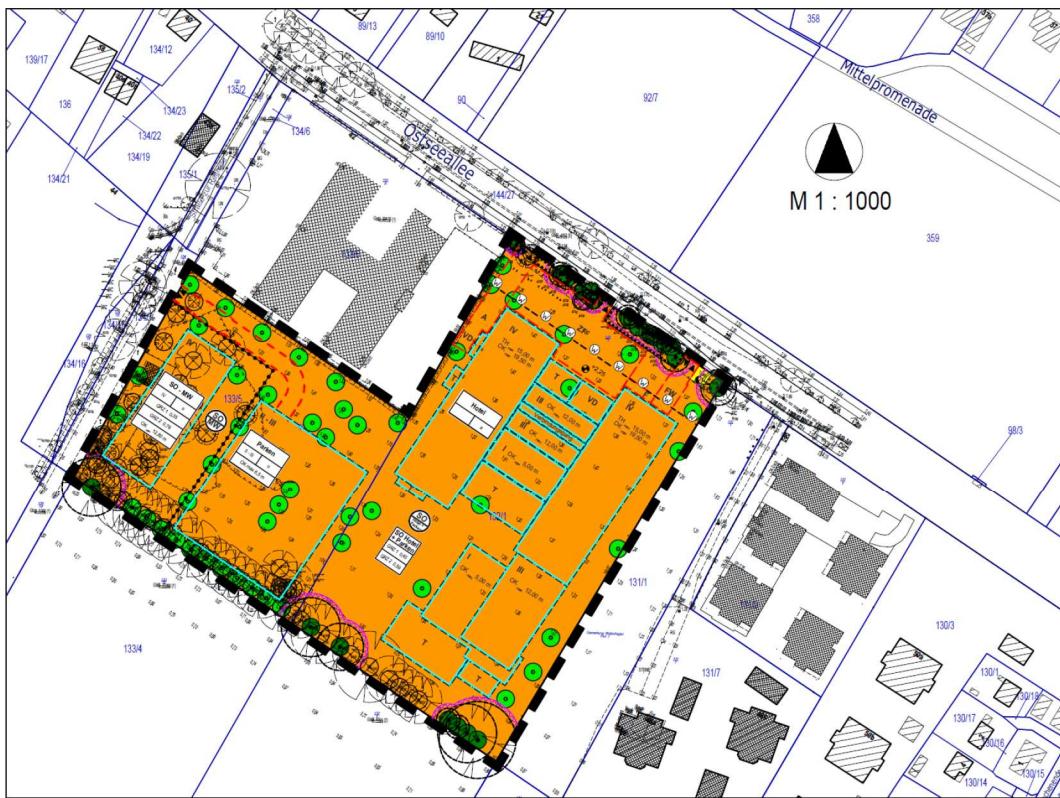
Planungsabsicht (Quelle: Planungsbüro Mahnel).
